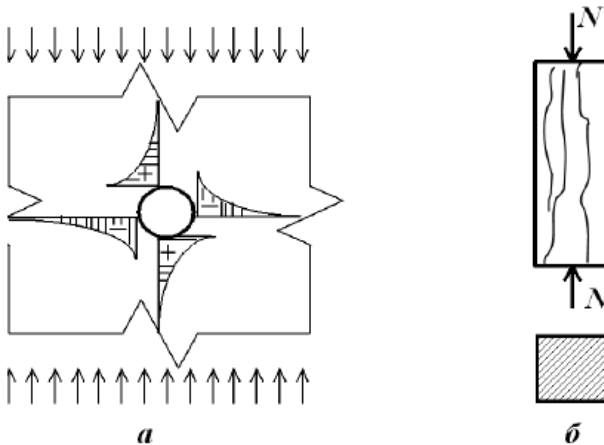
Схема напруженого стану бетонного зразка при стисканні:
